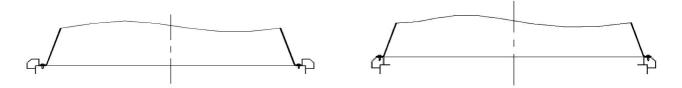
Конструкция присоединения воздуховодов к воздухонагревателю
